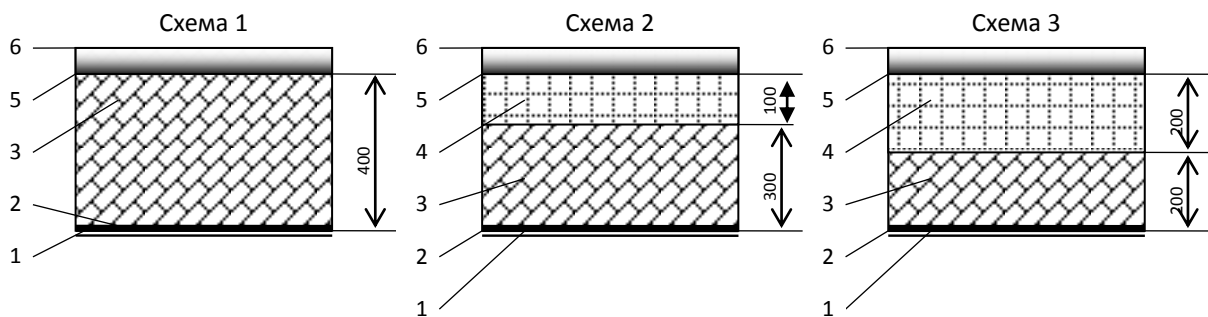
Схемы сталебетонных плит с утеплителем:
